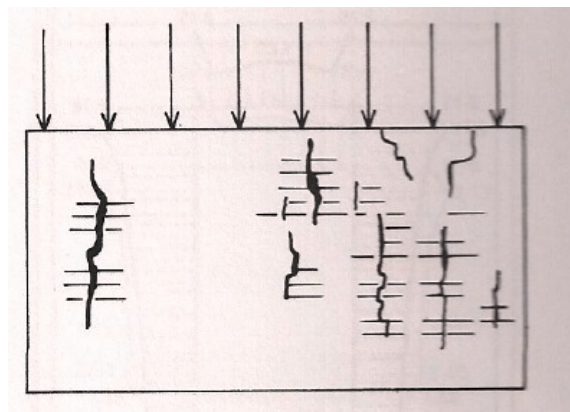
Fissuração típica da alvenaria causada por sobrecarga vertical
